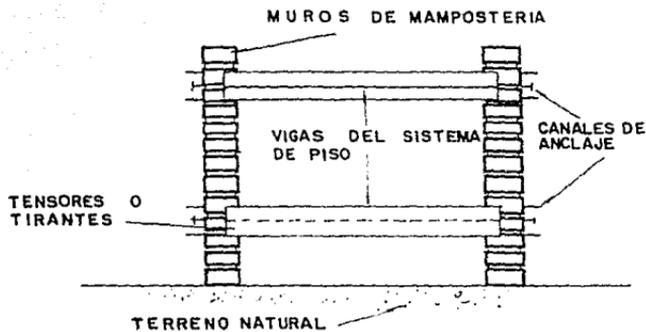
ANCLAJE DE MURO A MURO
